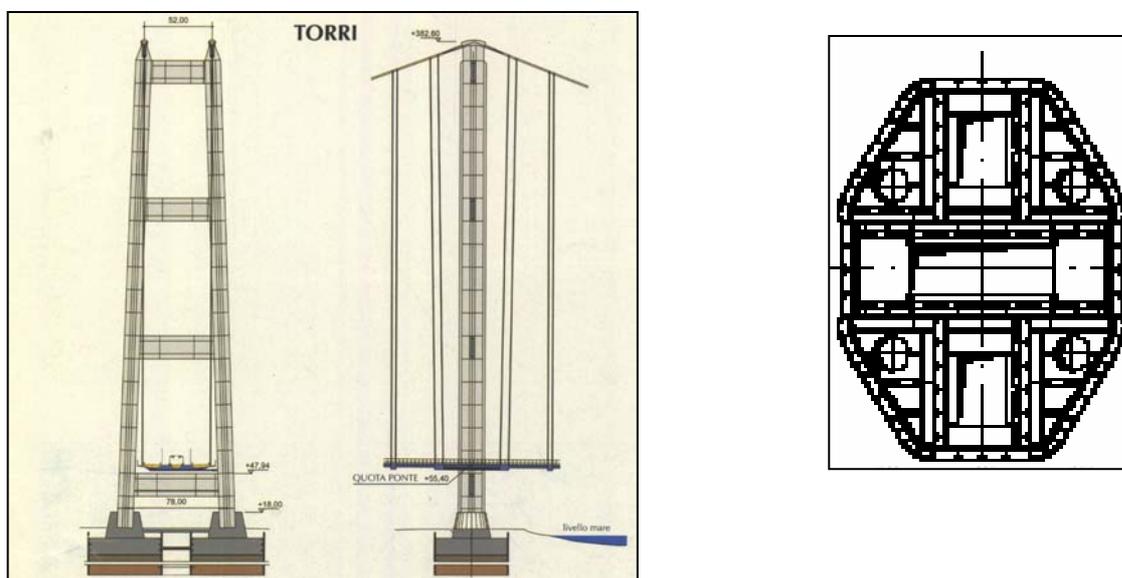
prospetti delle torri e sezione del concio tipo della gamba
